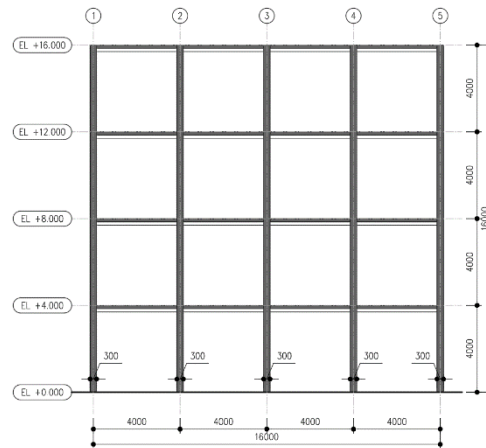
8. Potongan pada grid kolom pipih 250 mm × 640 mm
